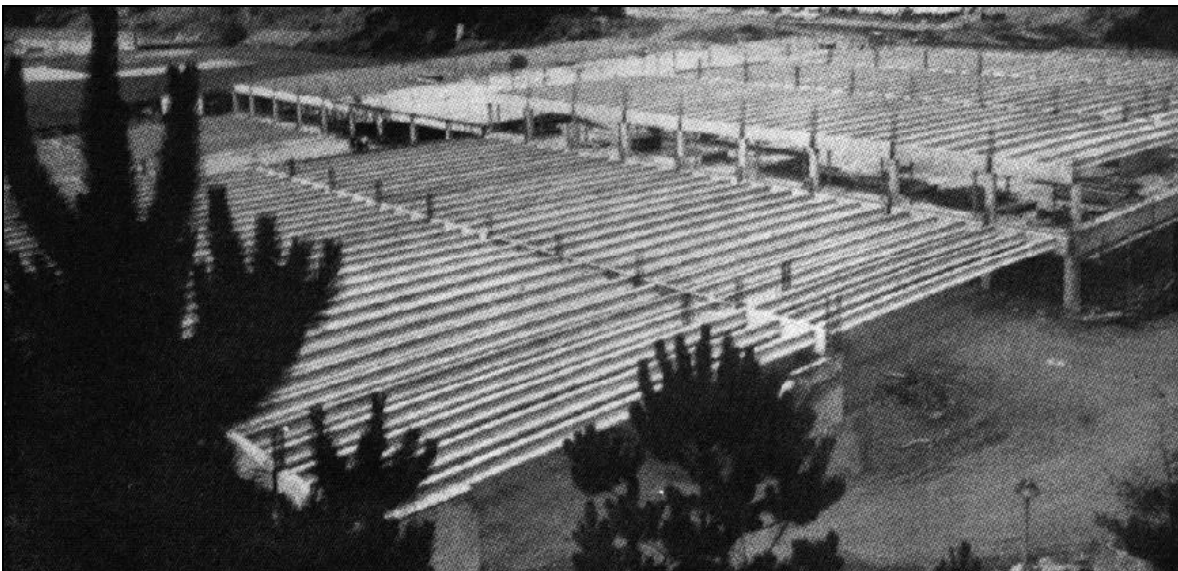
La viga y viguetas precoladas de concreto de agregados ligeros pretensado tendrán una cubierta de concreto de agregados ligeros trabajando en acción compuesta colada en el lugar. San Francisco, EE.UU.
